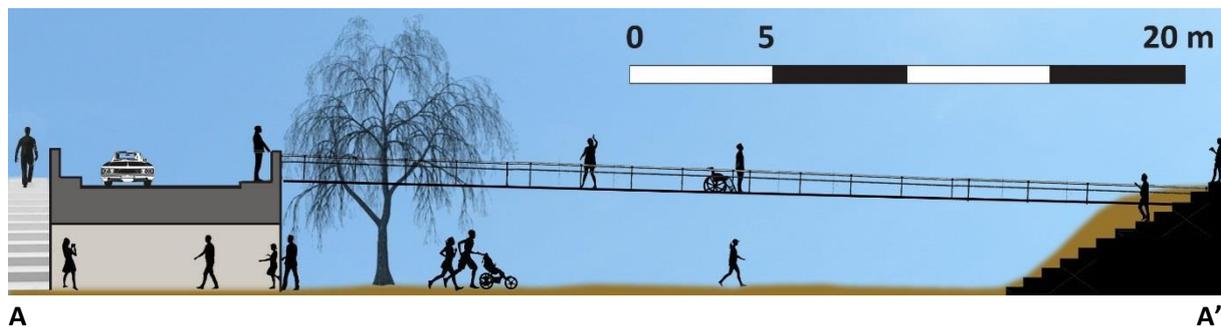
Projection avec escalier existant + marches dans le talus + passerelle PMR
